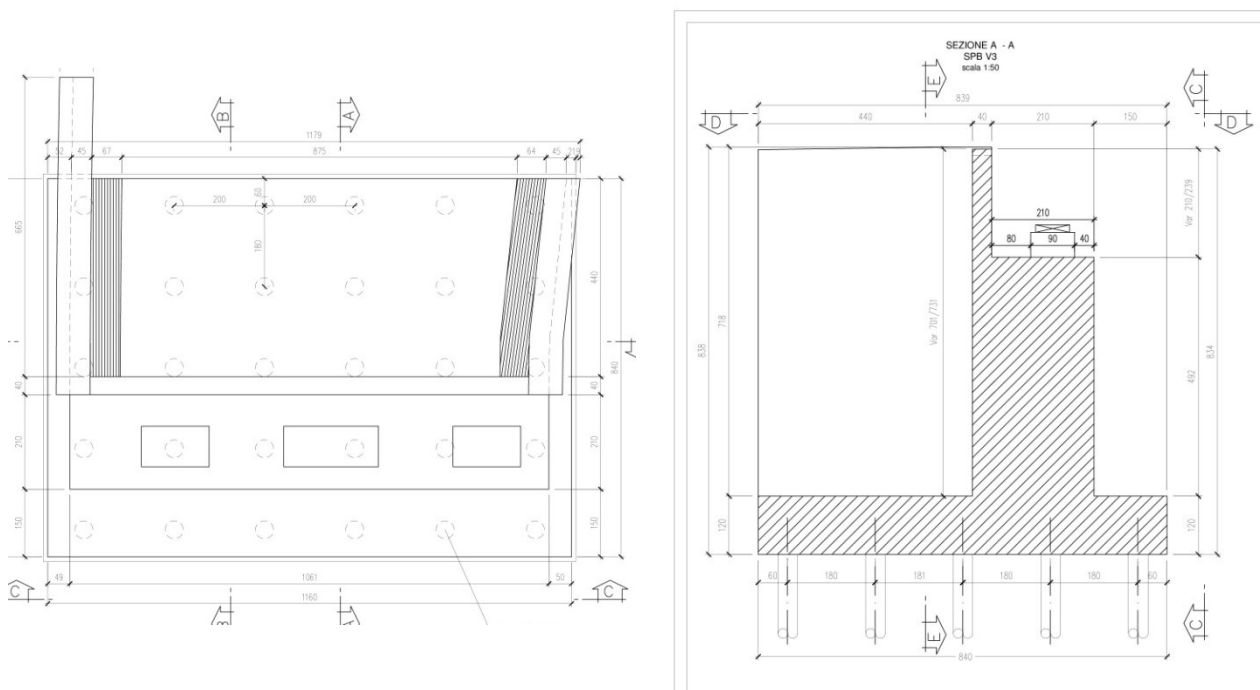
Spalla B: sezione longitudinale e pianta
